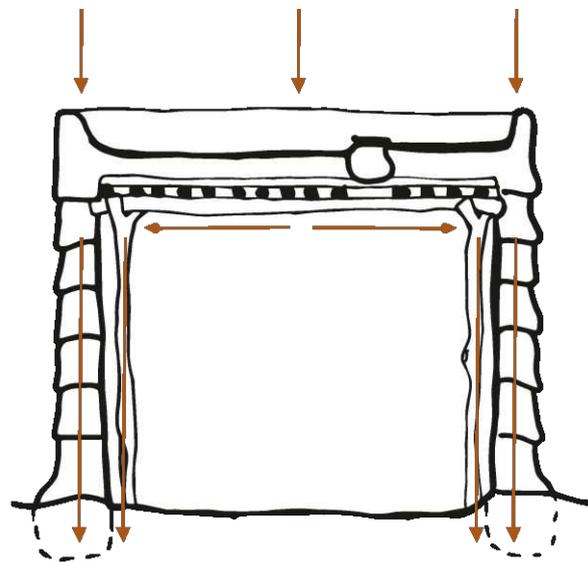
| Die Lastableitung einer traditionellen Flachdachkonstruktion
